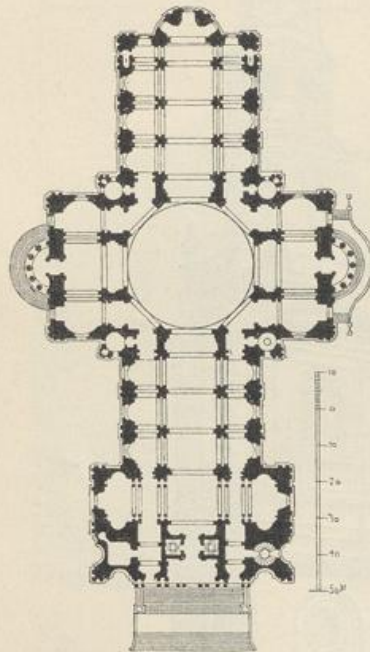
Grundriss der Pauls-Kathedrale zu London
